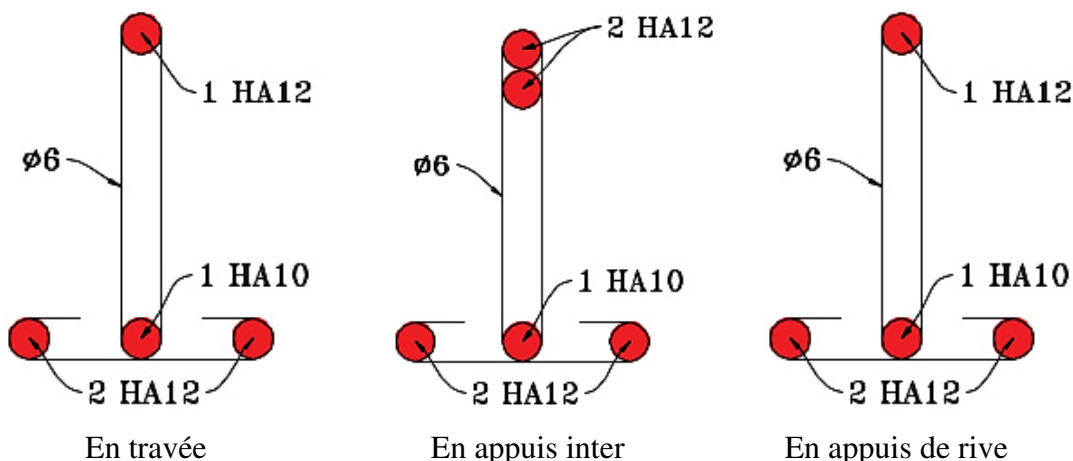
Schémas de ferrillage des poutrelles étage courant.
